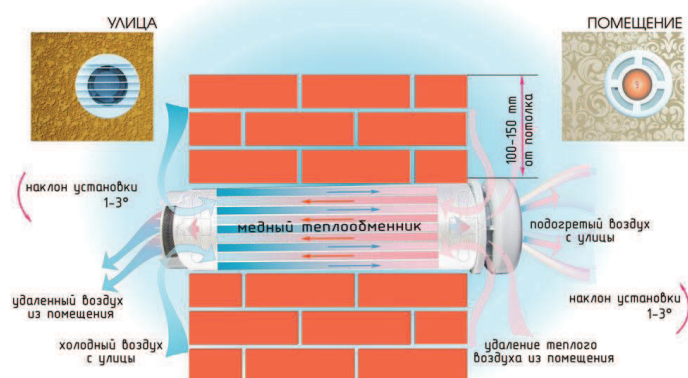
Принципиальная схема монтажа местной приточно-вытяжной установки с теплоутилизатором в стене здания
